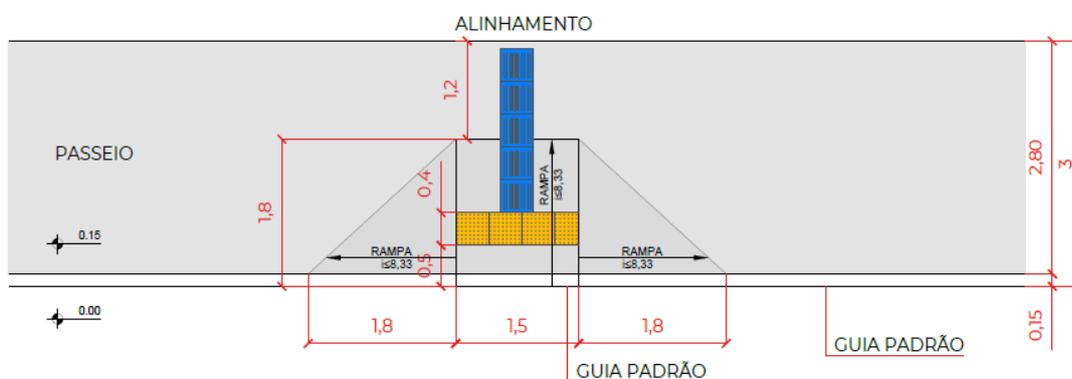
Rebaixamento de passeio. Fonte e elaboração: Polo Planejamento.
